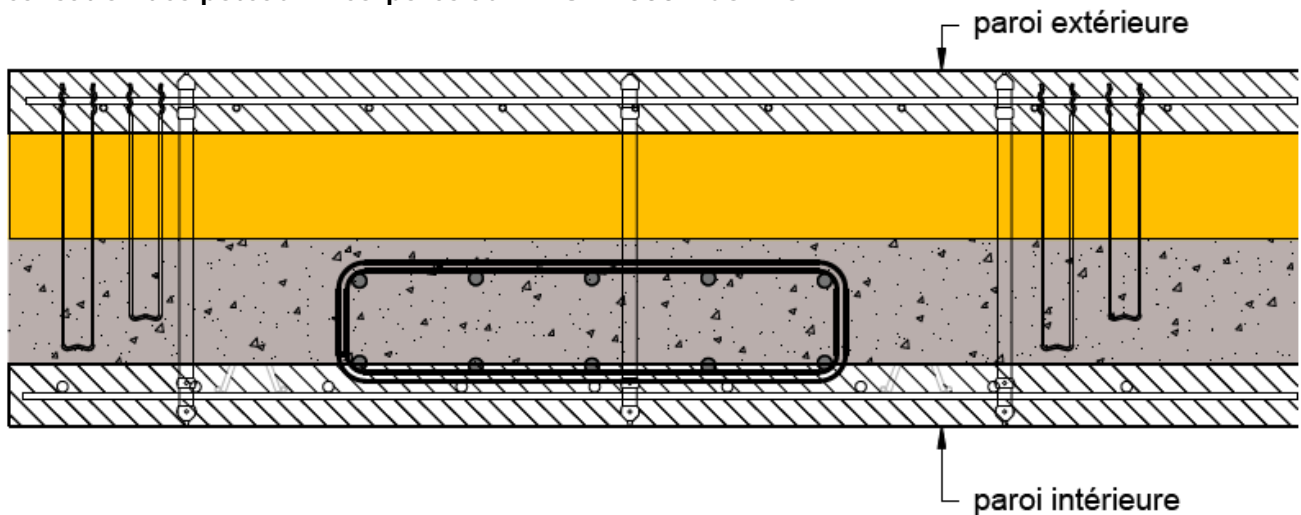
Exécution du ferrailage de poteau dans les murs 2000+ COMFORT
